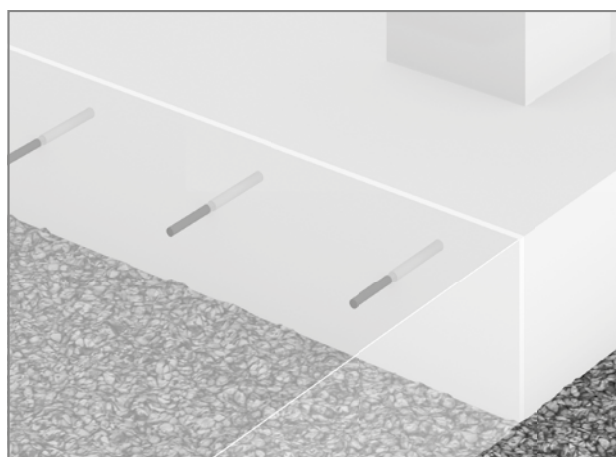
Schöck Dorn: giunto di dilatazione nella platea di fondazione
